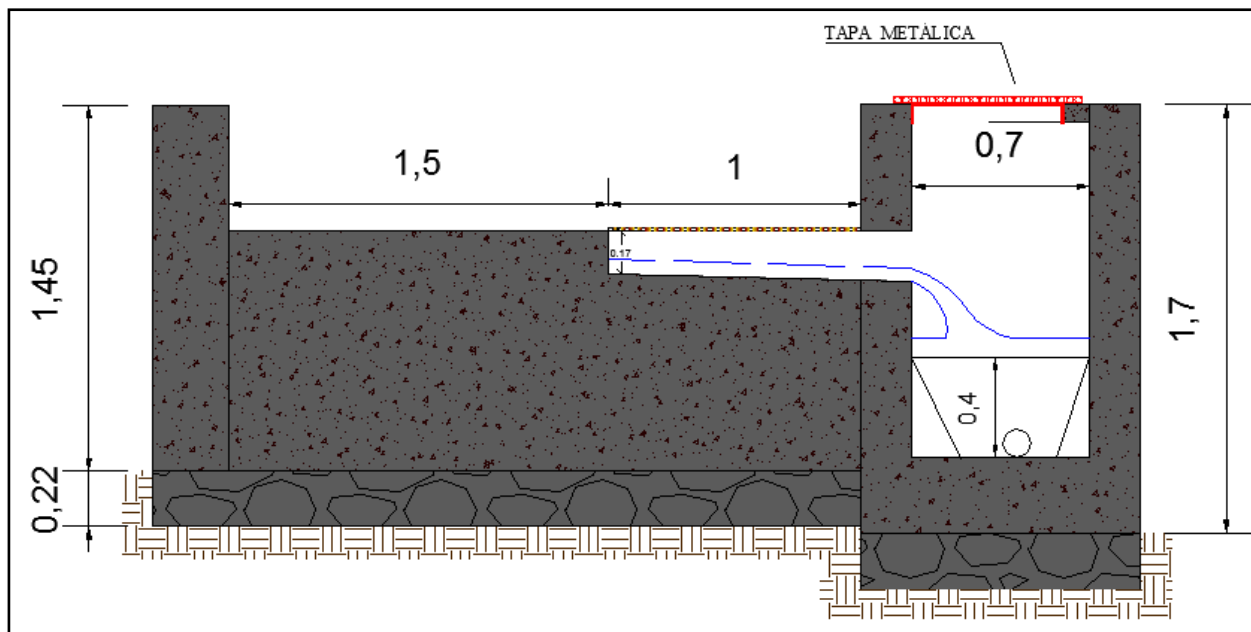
Sección transversal de la bocatoma proyectada. Fuente: Autores del proyecto.
